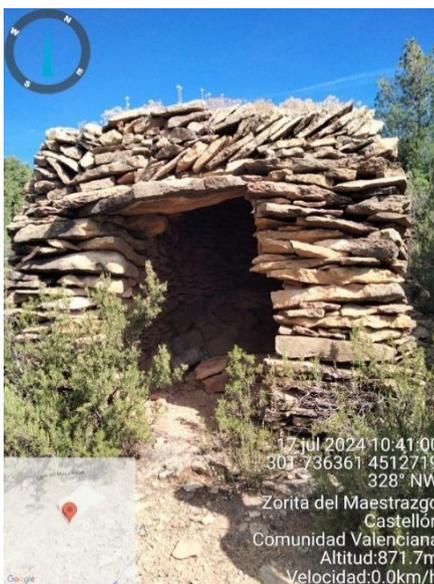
Caseta de piedra en seco. Fuente: elaboración propia.
